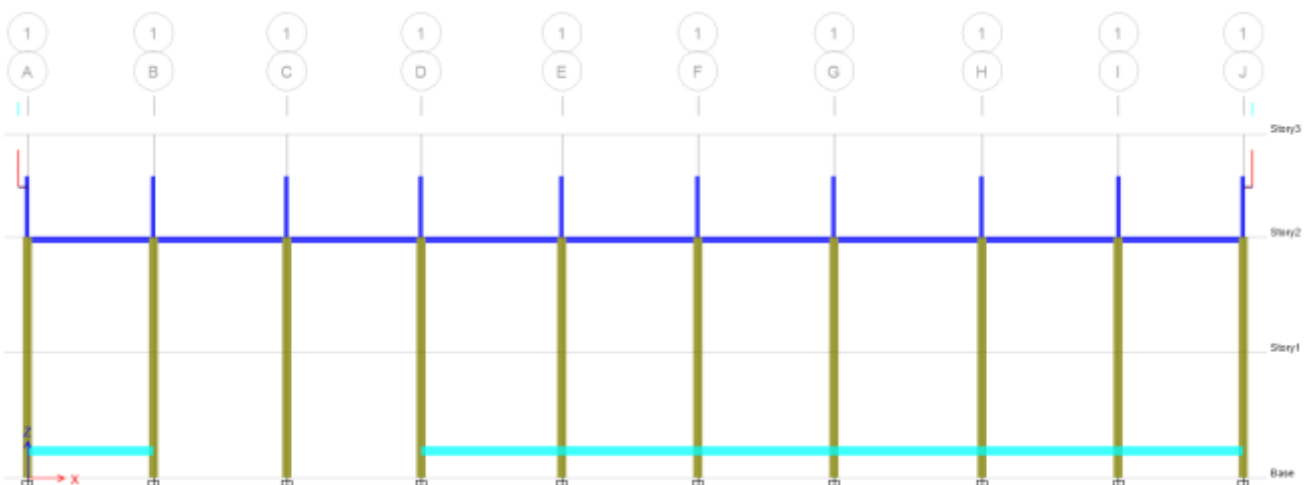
Vigas de amarre en el modelo. Fuente: Propio.
